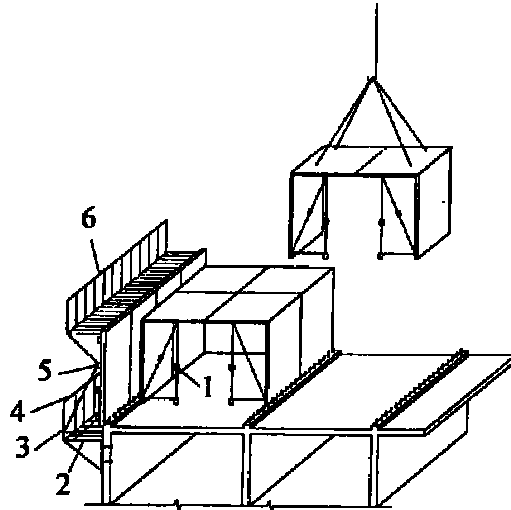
Схема установки щитів об'ємно-переставної опалубки: 1 — механічні домкрати; 2 — консольні підмости; 3 — телескопічні похилі стійки для кріплення щитів; 4, 6 — огорожування; 5 — торцевий щит опалубки
